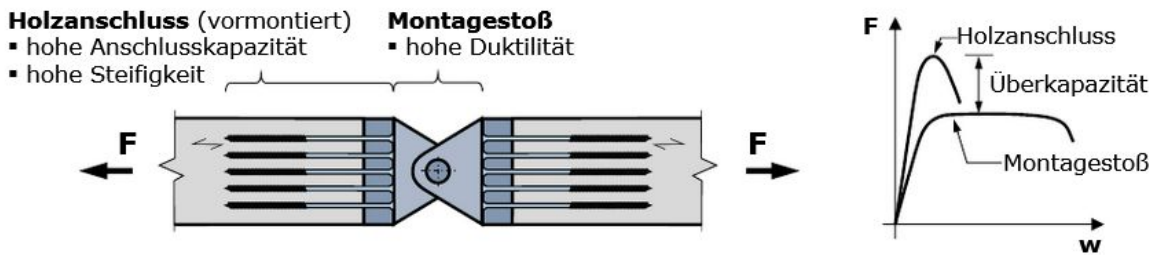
Konzept eines Hirnholzanschlusses: Holzanschluss mit axial-beanspruchten Holzbauschrauben und Stirnplatte und duktil versagender Stahl-Stahl Montagestoß, aus [19]
